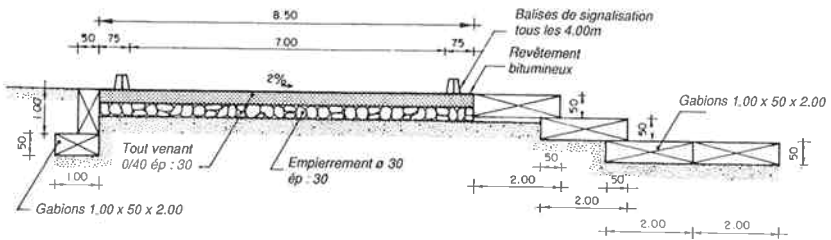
Radier sur sol affouillable avec chaussée souple
